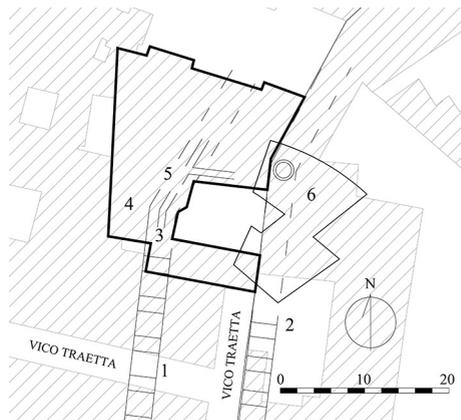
Palazzo de’ Mari: 1) ponte-canale dell’acquedotto augusteo; 2) ponte canale est; 3) sezione dello speco augusteo; 4) piegatura della parete ovest del canale augusteo; 5) intersezione dello speco augusteo con quello trasversale; 6) cisterna con pilastro con pozzo. La linea in grassetto indica i confini del palazzo, l’altra quelli della cisterna.
